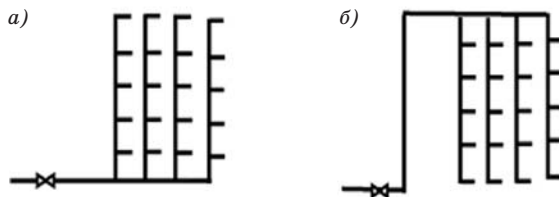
Схема тупикового водопровода: а — с нижней разводкой; б — с верхней разводкой
